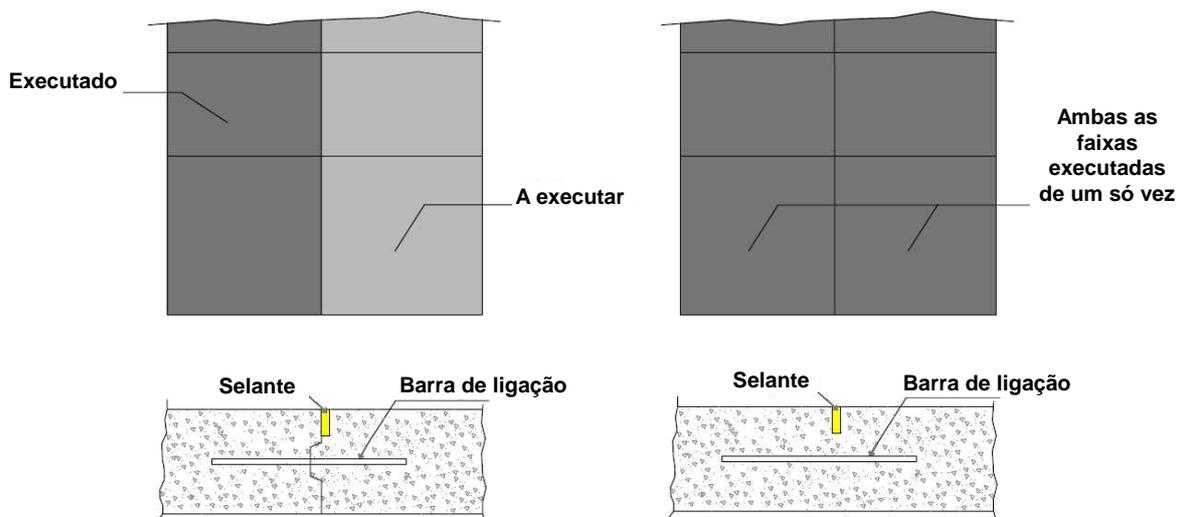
Juntas longitudinais de articulação no caso de execução do pavimento faixa a faixa ou duas faixas numa só passagem.
